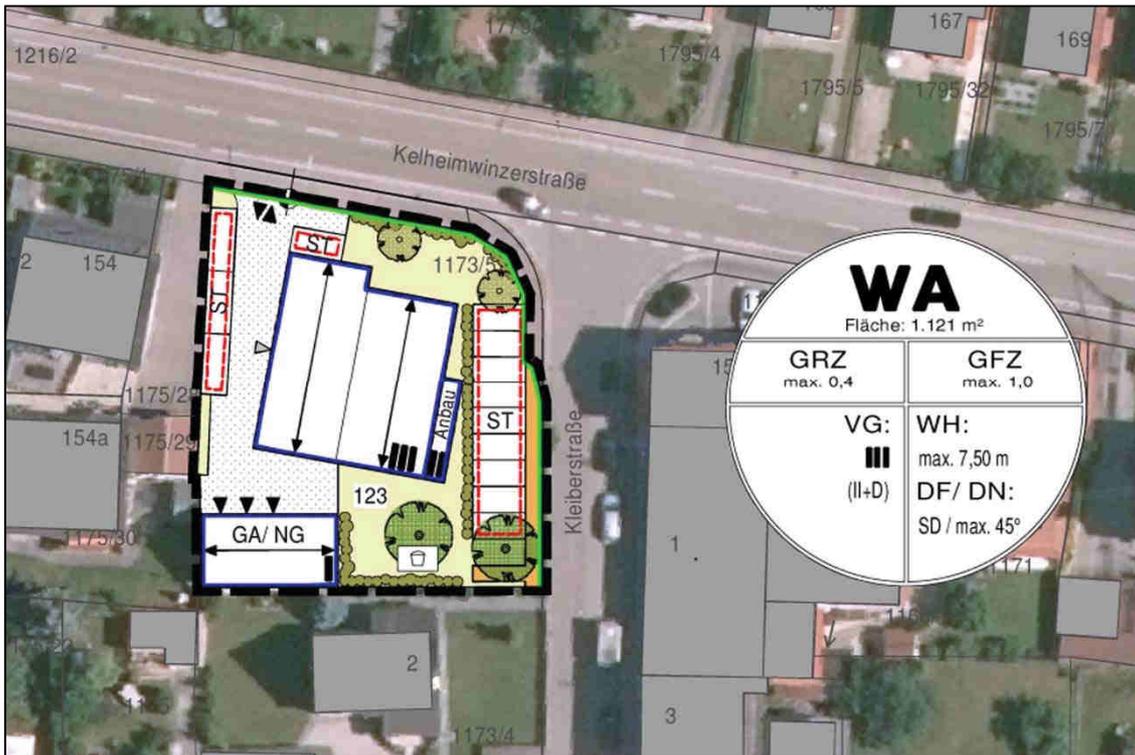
Planzeichnung zum Deckblatt Nr. 02 des Bebauungsplans Nr. 04 /12/
